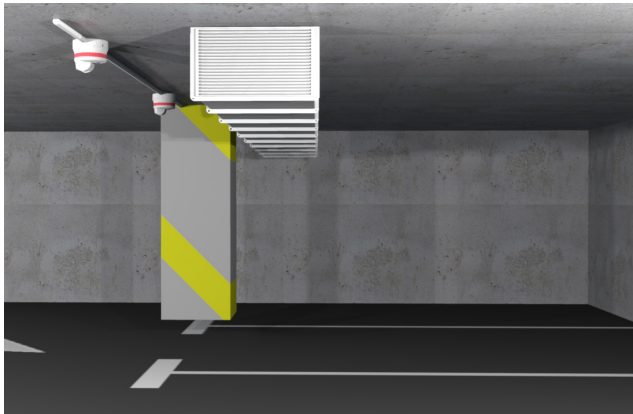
Der Sockel des Sensors muss mindestens 5 cm unter dem Hindernis liegen
